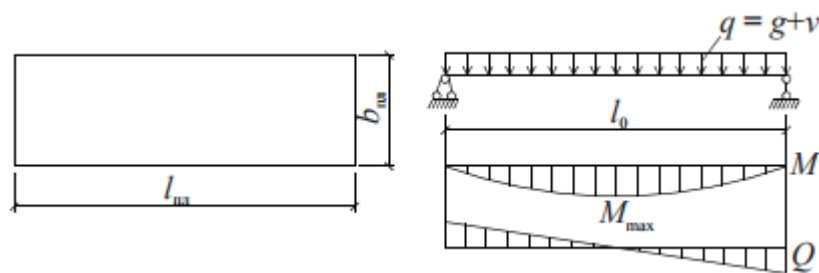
Розрахункова схема та епюри внутрішніх зусиль в багатопустотній плиті перекриття.
